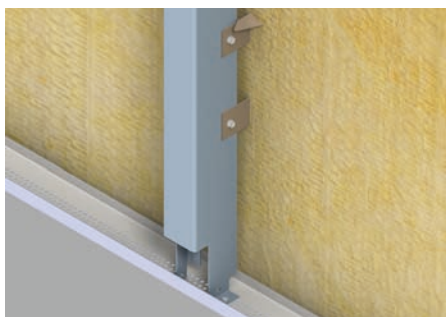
Fußprofil vor Montage des ersten Planumprofiles
